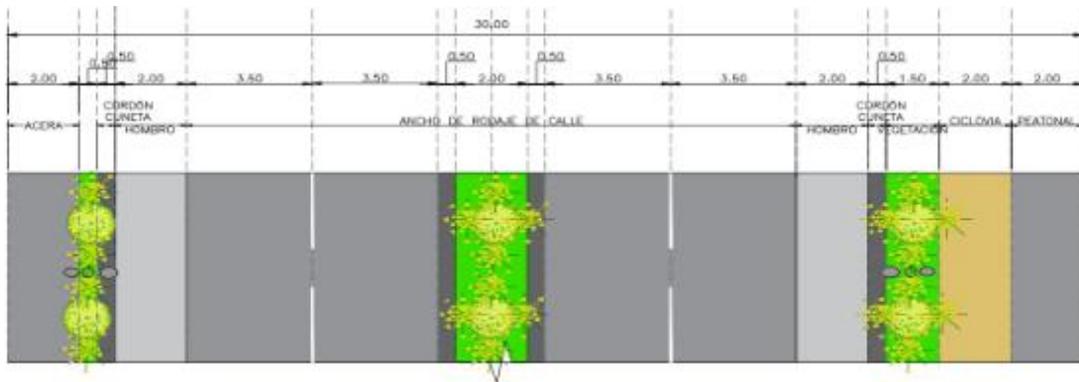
Planta Tipo Propuesta, sector ampliación a 4 carriles para la CA02
